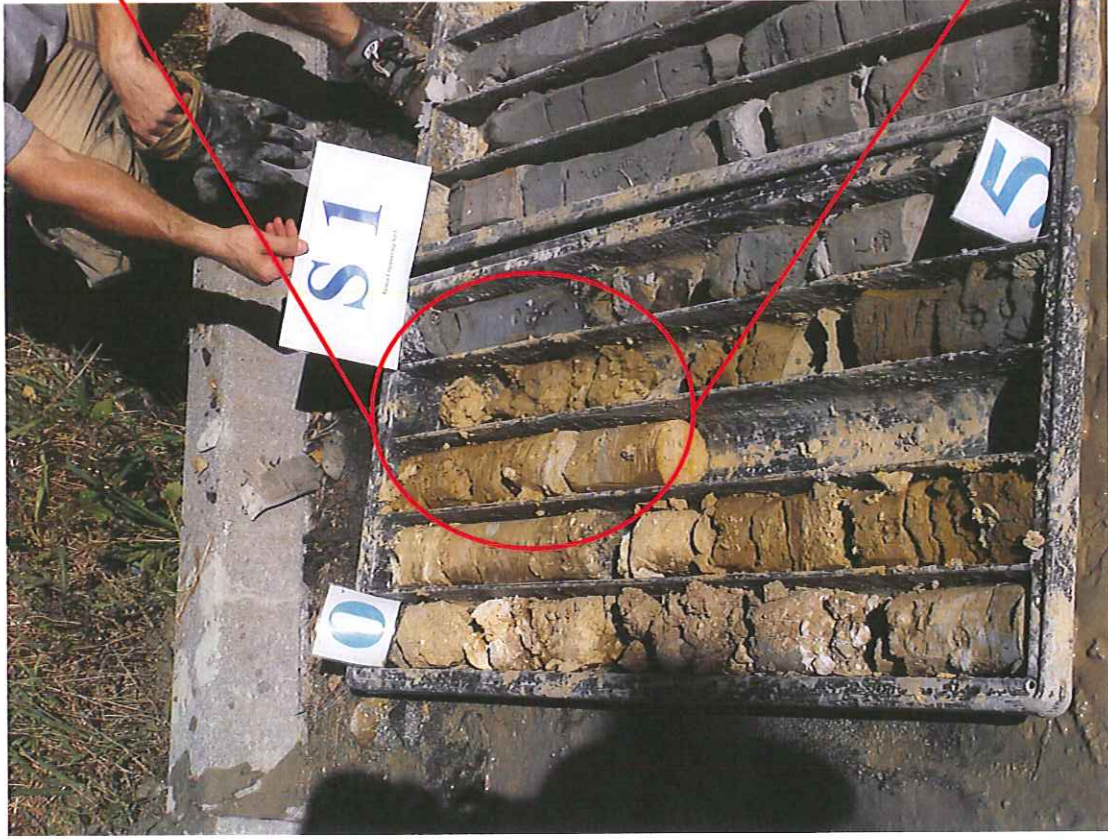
Sondaggio S1 da 0.00 m a – 5.00 m
